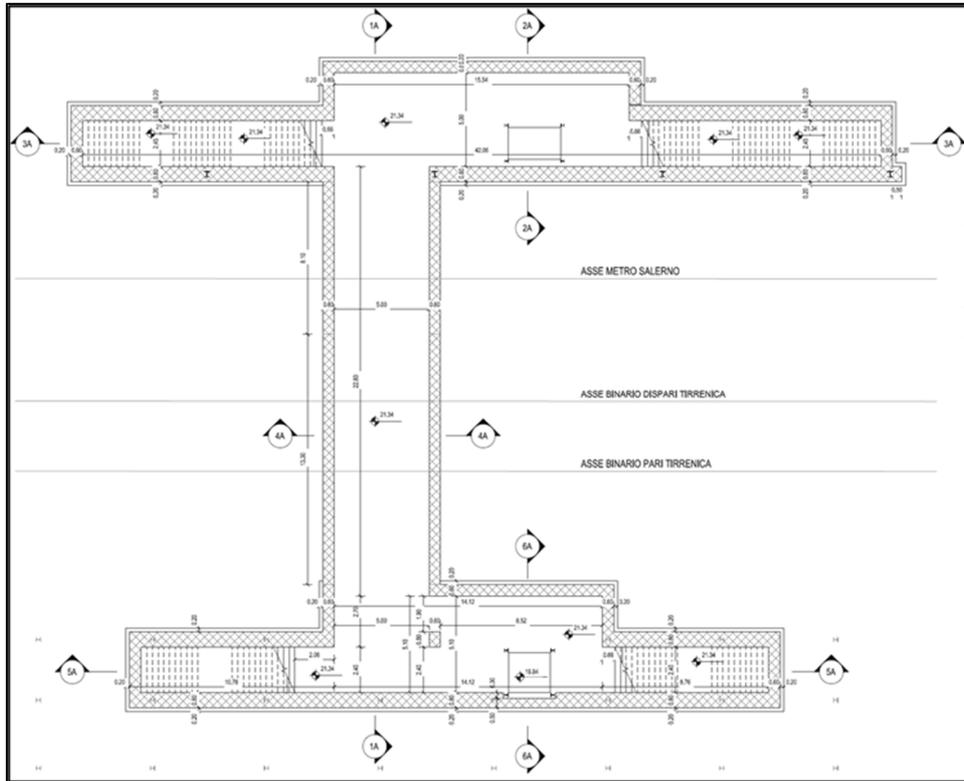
Pianta estradosso fondazione sottopasso pedonale
